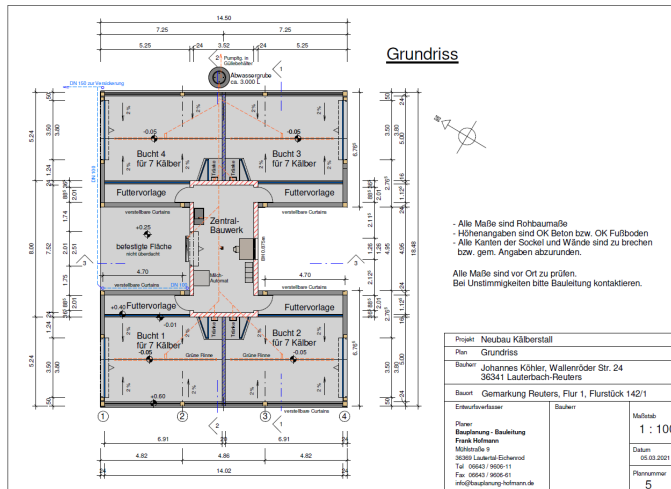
Grundriss des H-Stalles (© P. Zieger)
